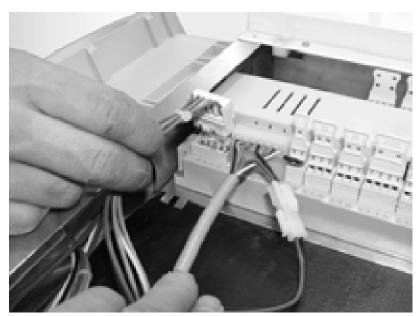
Das Kabel vom Kesselschaltfeld für die Spannungsversorgung des Kesselreglers (Steckkontakt L, PE, N, L1, S3) an der Regelung anschließen.
